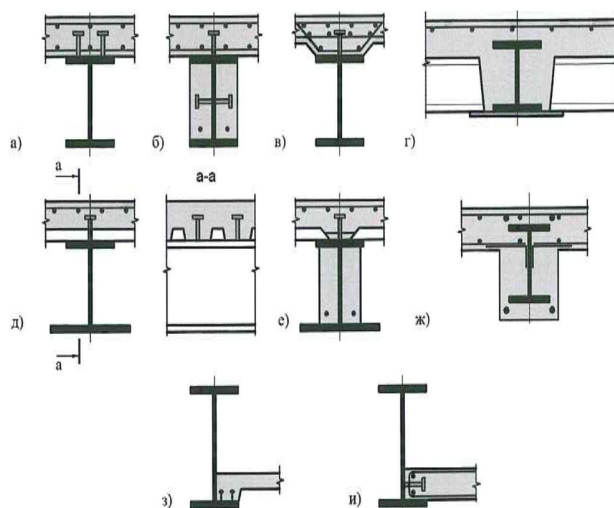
Основные типы поперечного сечения комбинированных сталежелезобетонных балок
